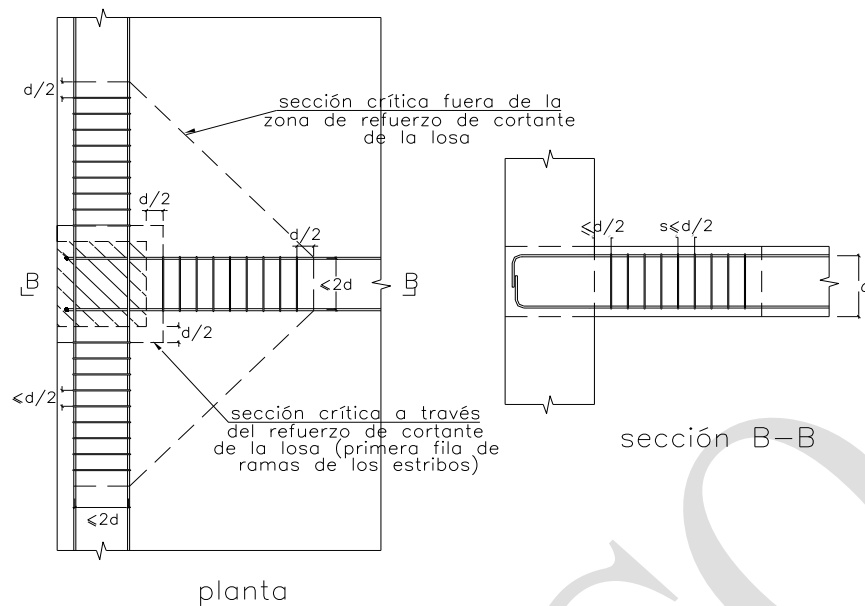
b Disposición de los estribos por cortante en columnas de borde.
